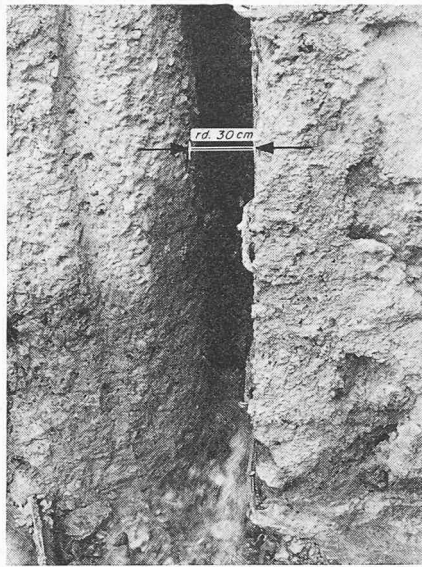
Klaffende Fuge zwischen zwei Wandelementen. Starker Wasseraustritt auf der Höhe des jeweiligen Aushubplanums
